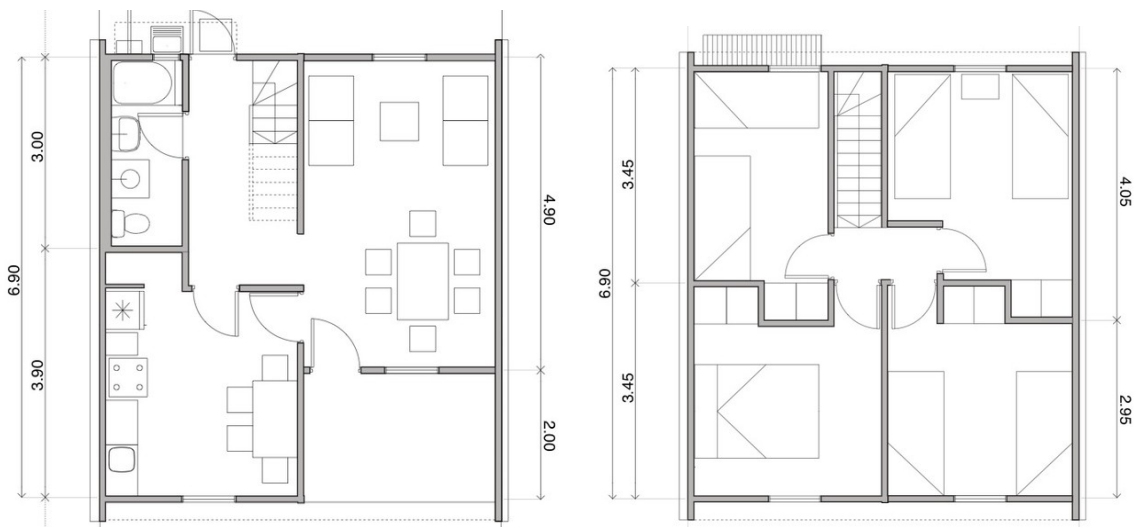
Projeto com ampliação do conjunto Villa Verde. Fonte: ArchDaily: Habitação Villa Verde / ELEMENTAL
